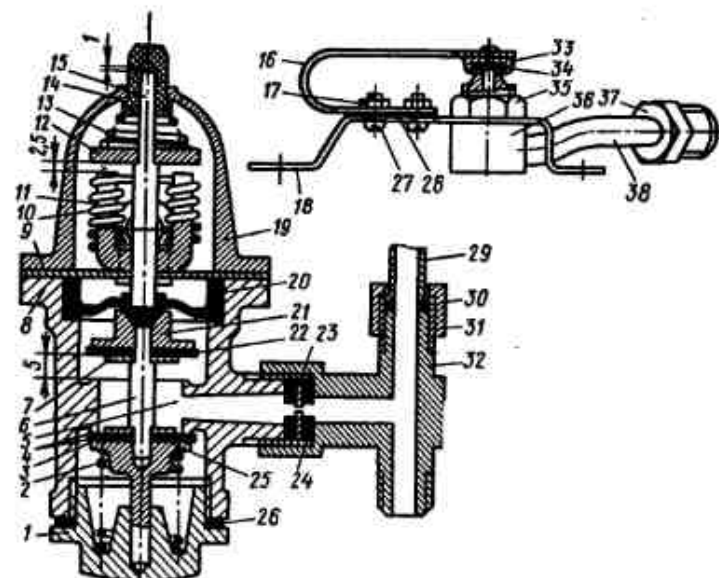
Газовый магнитный клапан с датчиком тяги водонагревателя АГВ-80:
